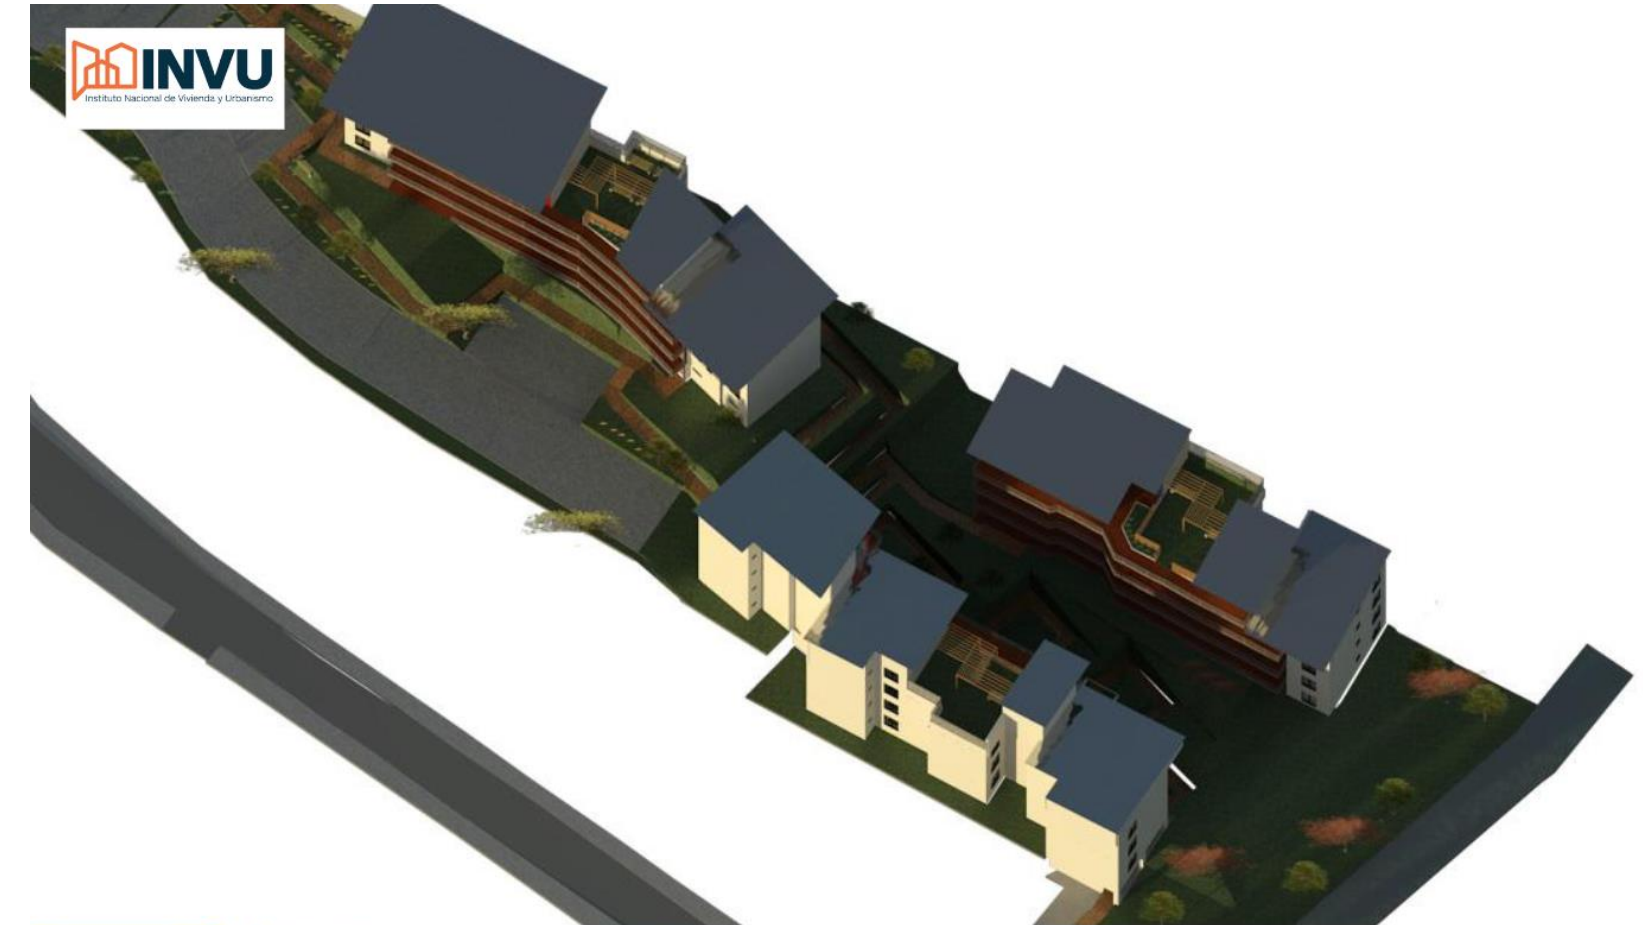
Vista Conjunto Residencial Lumen. Fuente: : Peralta, J. (2018). Plan Integral de Intervención en Guararí, Pág. 54.
